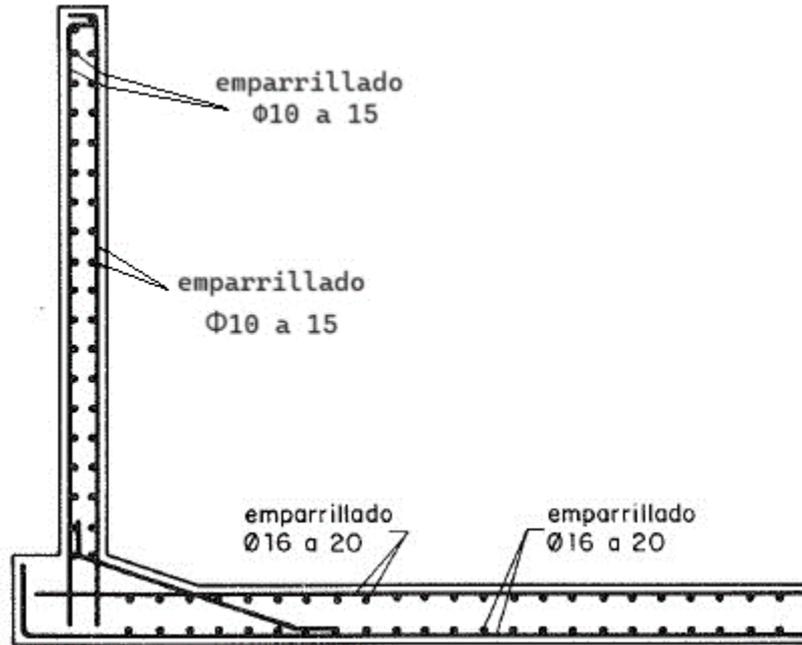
Sección transversal del digestor primario. Fuente: Elaboración propia
